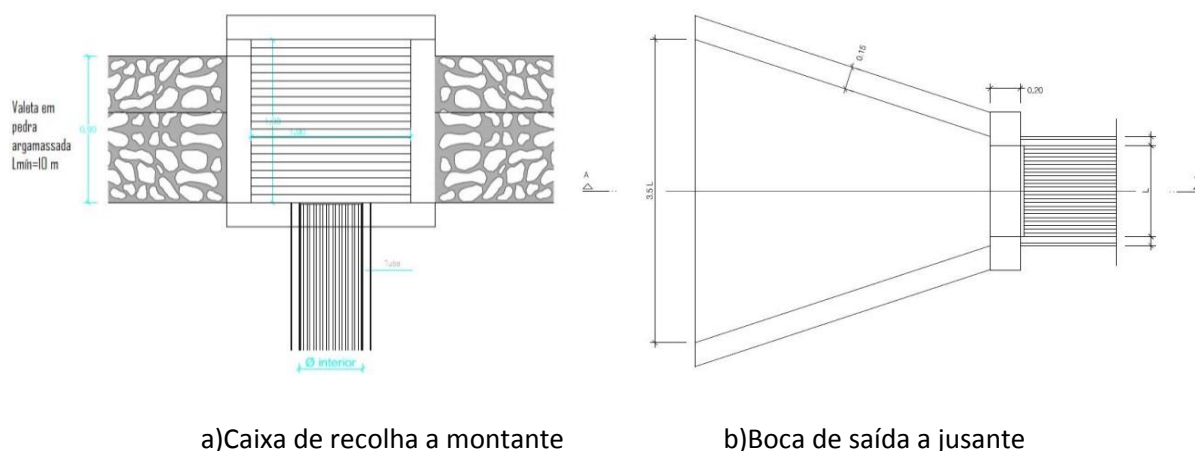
Pormenores em planta de elementos exteriores de PH tipo³²
